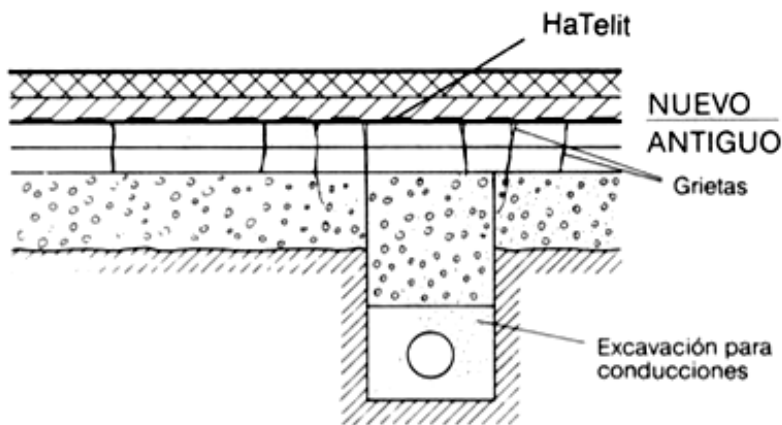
Ejemplo de una armadura cubriendo la superficie entera de un refuerzo aplicado sobre una estructura deteriorada por una excavación para cañerías.
